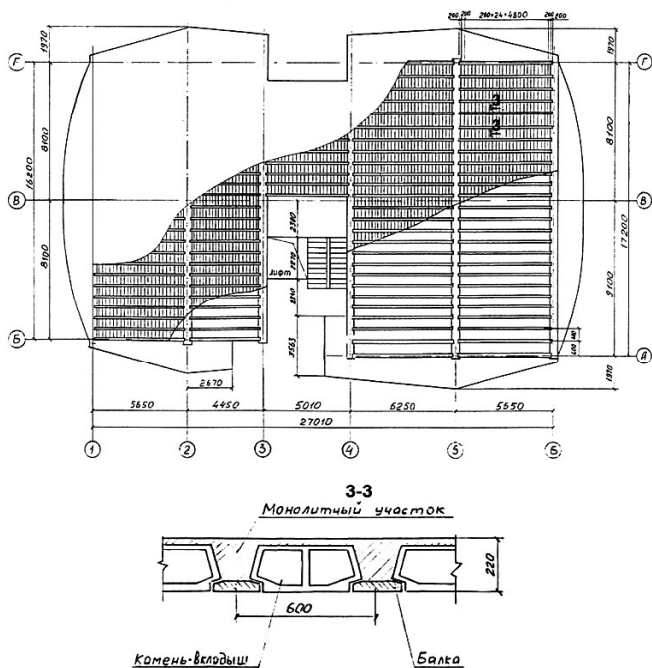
Сборно-монолитное перекрытие с керамическими пустотелыми вкладышами
